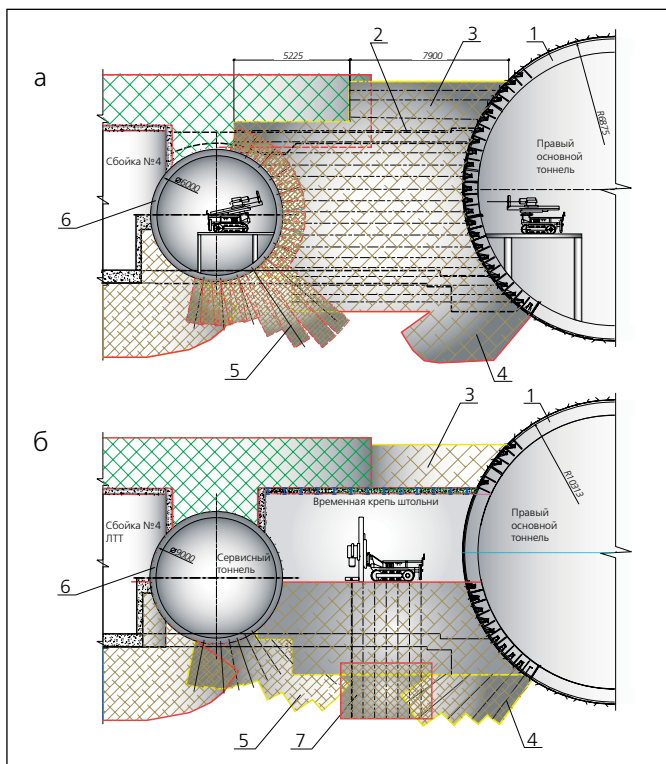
Укрепление грунтов по сбойке № 4: а – из ПТТ и СТ; б – из верхней штольни; 1 – обделка основного тоннеля; 2 – проектный контур штольни; 3 – зона грунта, закреплённого горизонтальными ГЦС из основного тоннеля; 4 – наклонные ГЦС из основного тоннеля; 5 – наклонные ГЦС из сервисного тоннеля; 6 – обделка сервисного тоннеля; 7 – зона грунта, закреплённого вертикальными ГЦС после проходки верхней штольни
